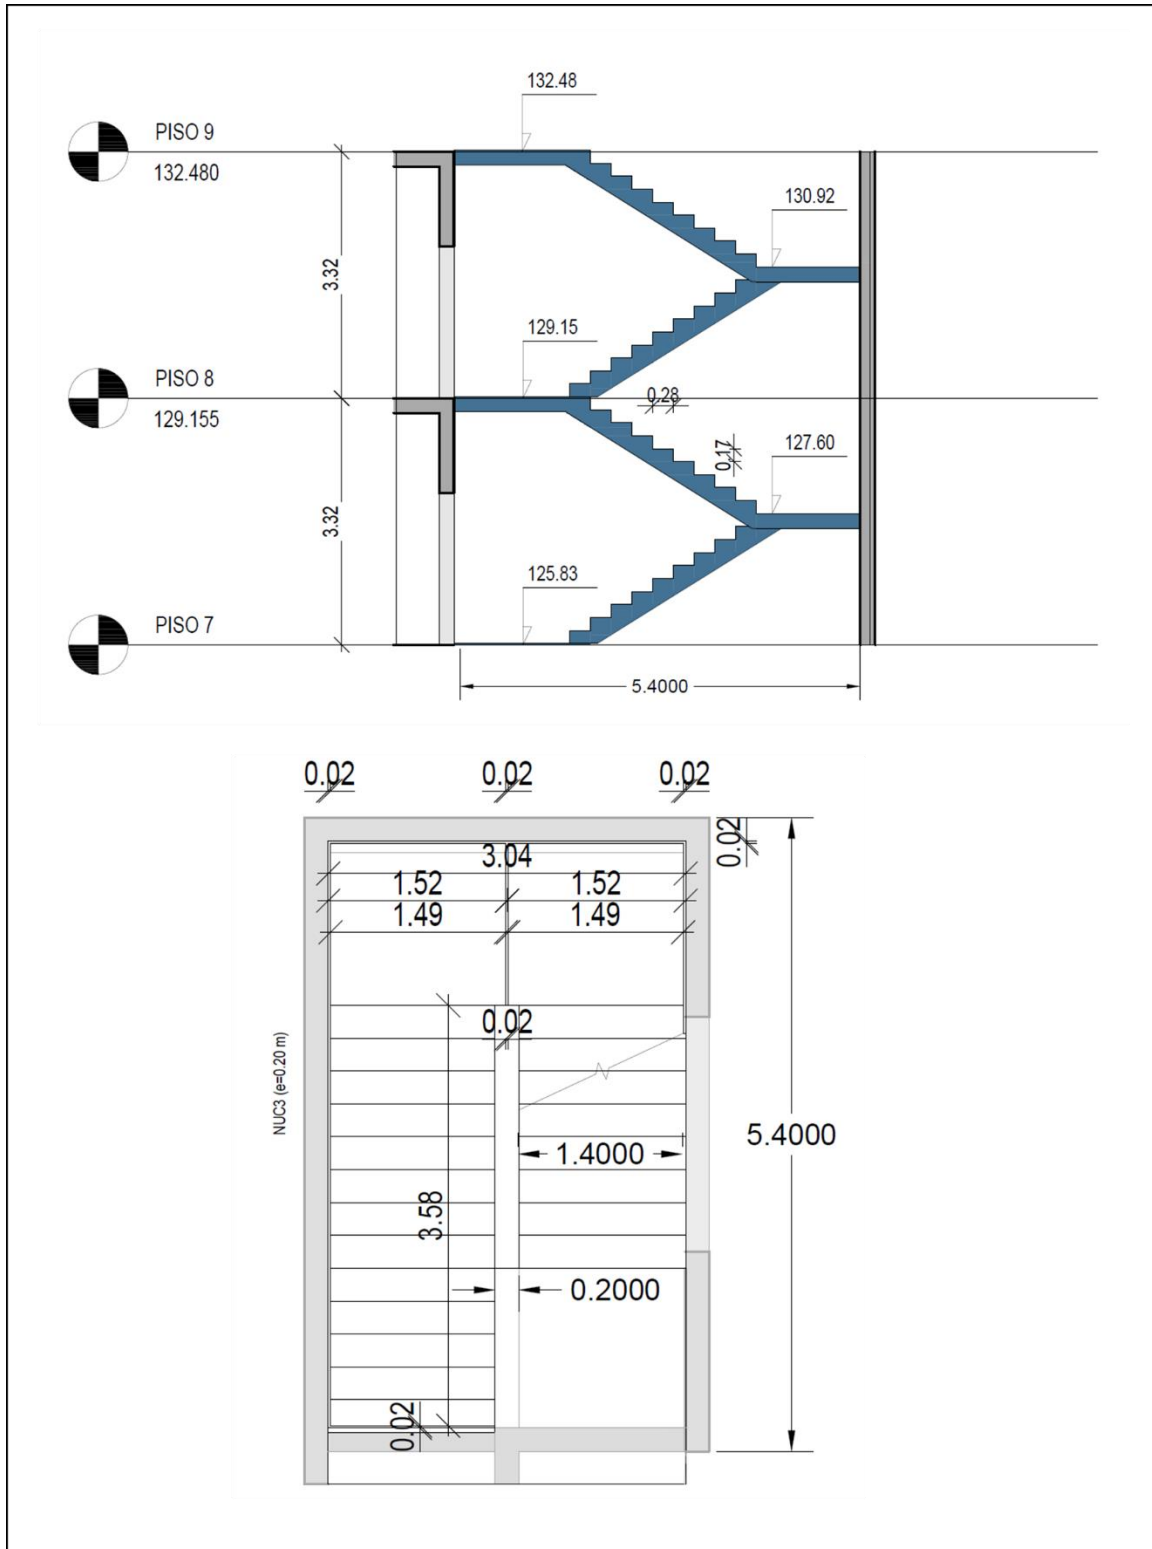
Corte do piso 7 e 8 e vista em planta do núcleo de escadas. Fornecido pela TopBIM.
